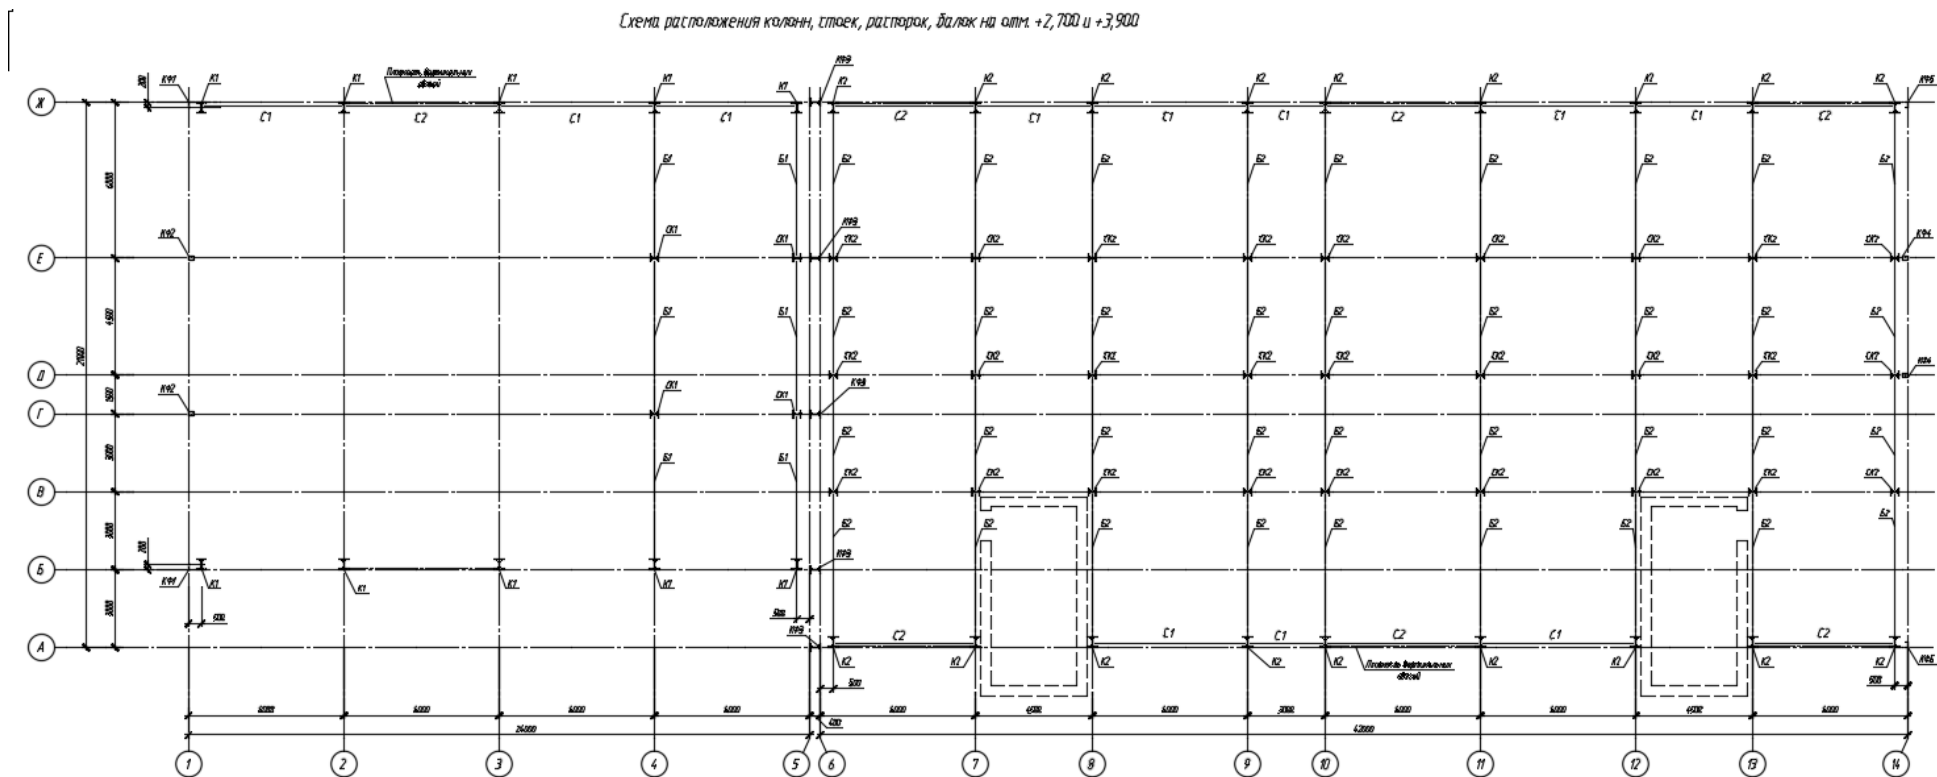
Схема расположения колонн и балок междуэтажного перекрытия
